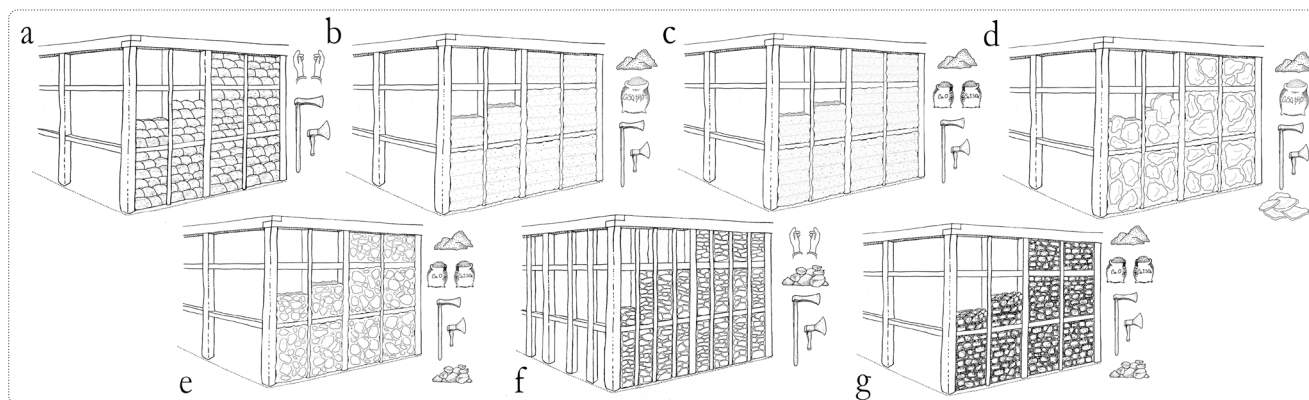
Clasificación de las variantes materiales con rellenos monolíticos: a) tierra apilada, b) tapialete, c) hormigón de cal y tierra, d) lascas de piedra verticales encofradas, e) mampostería encofrada, f) mampostería apilada y g) mampostería ordinaria. Dibujo elaborado por los autores
